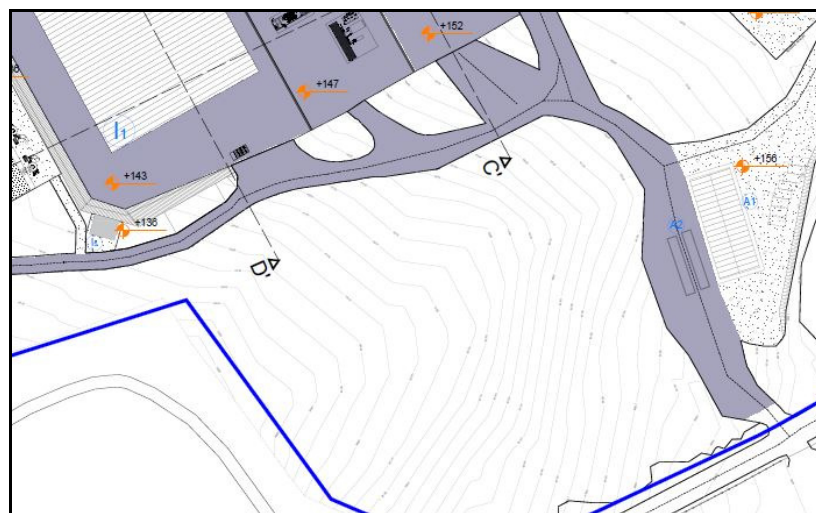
Stralcio planimetria compostaggio con piazzola 8B rimossa (stato modificato)
